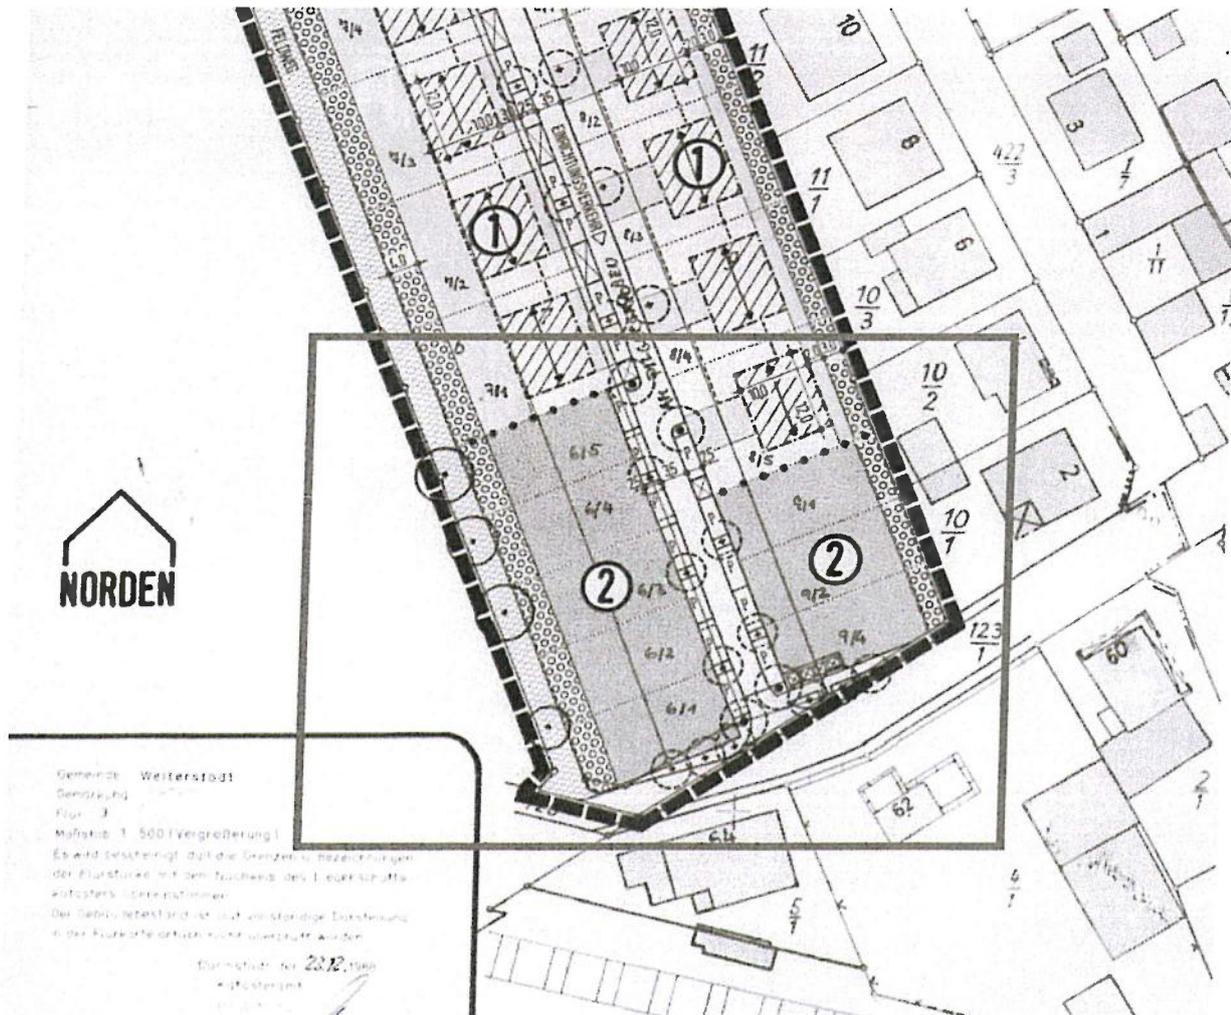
Planzeichnung des Bebauungsplans „Nördlich der Pumpstation“
